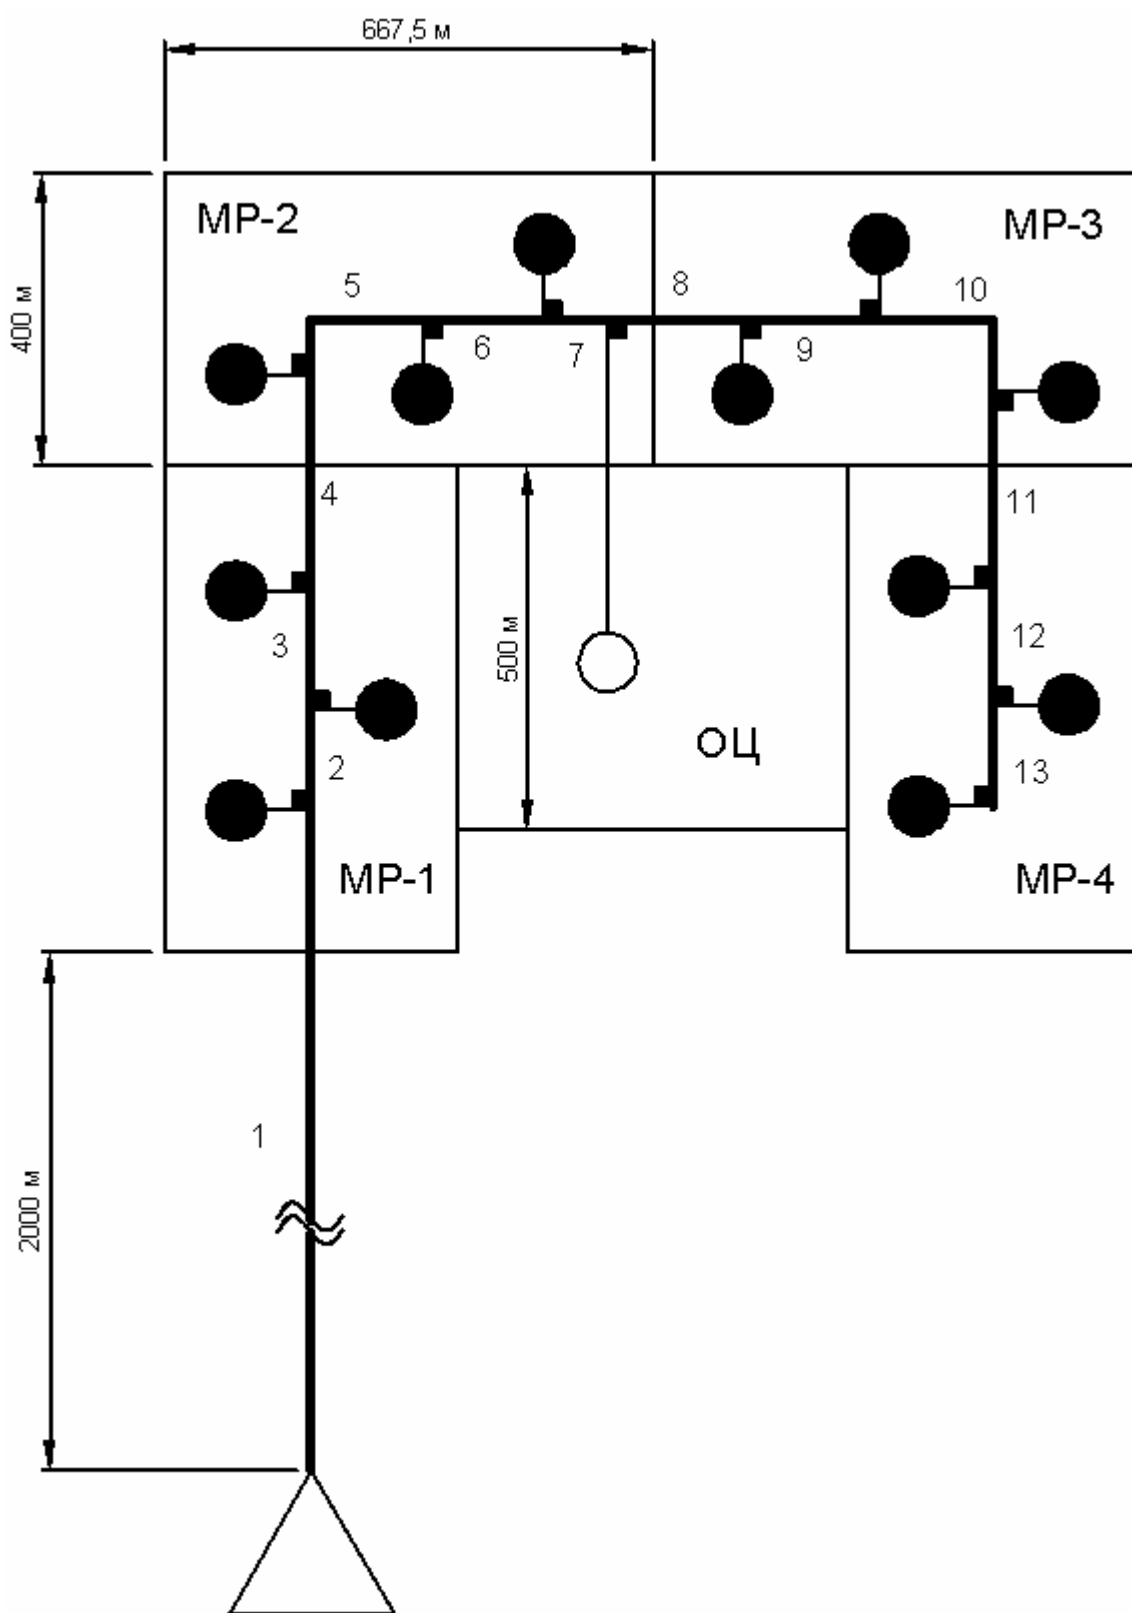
План района теплоснабжения и трассы теплопроводов.
